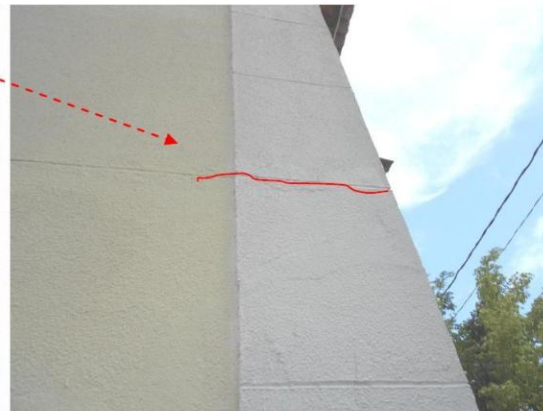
Detalhe 2 da fissuração na fachada lateral esquerda.
